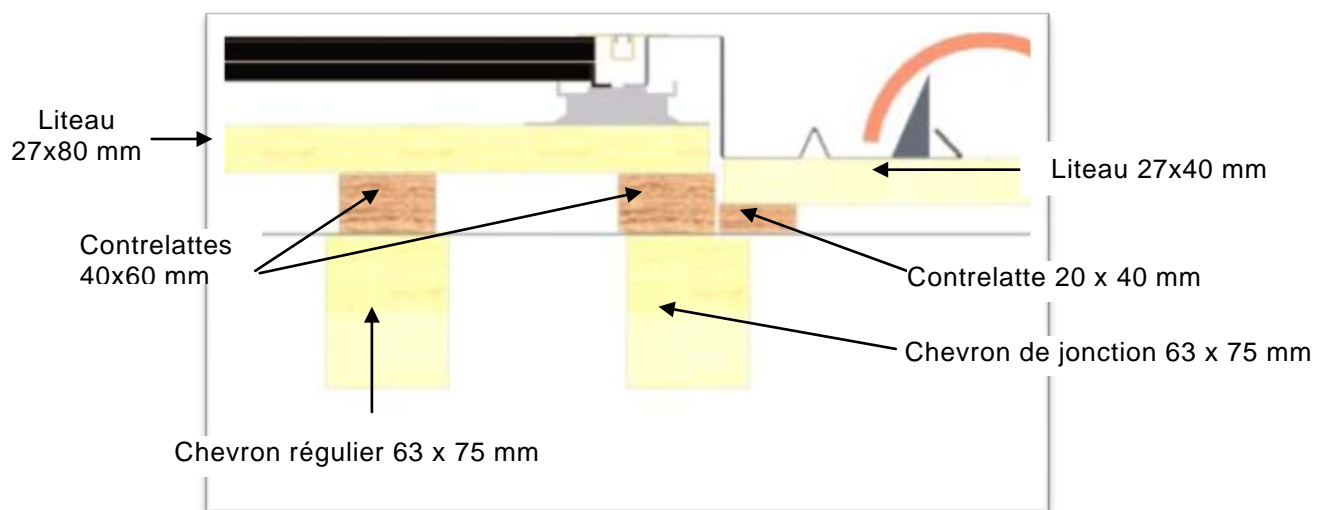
Vue en coupe transversale d'une toiture avec écran de sous-toiture existant
